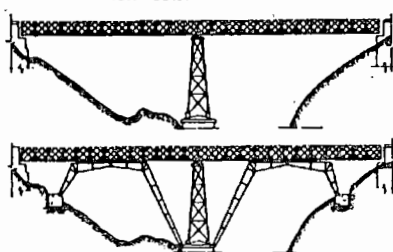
Reforço em viga treliçada contínua com pórticos criando quatro apoios
